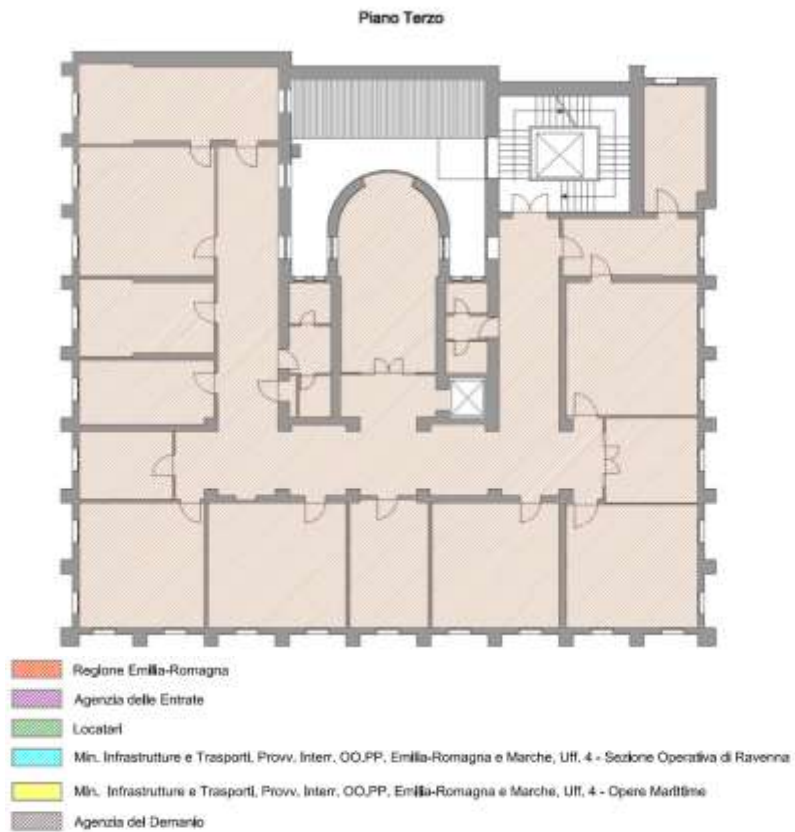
Pianta degli spazi occupati: piano terzo.
